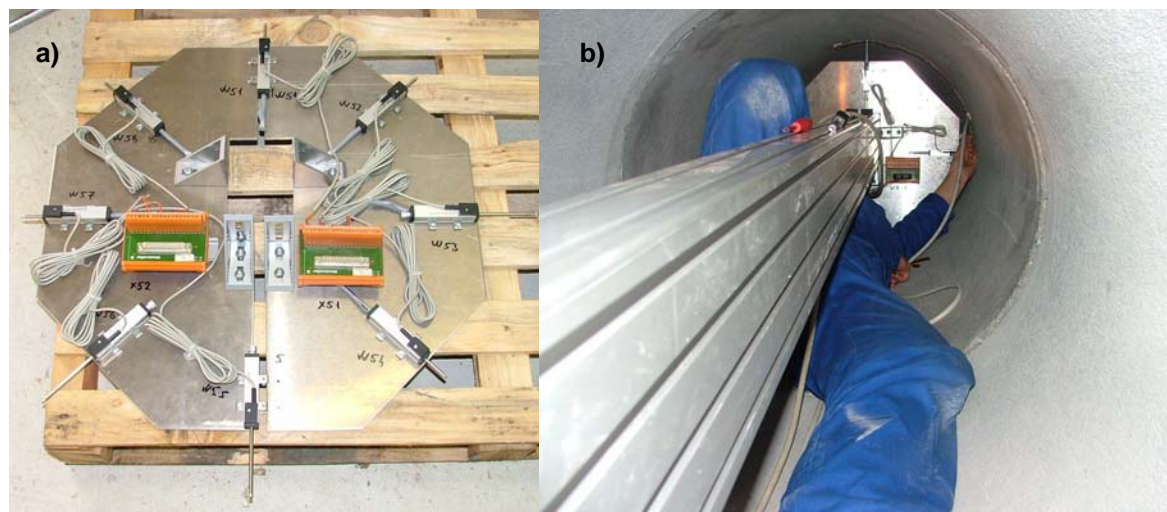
Einbau der Wegaufnehmerkonstruktion
